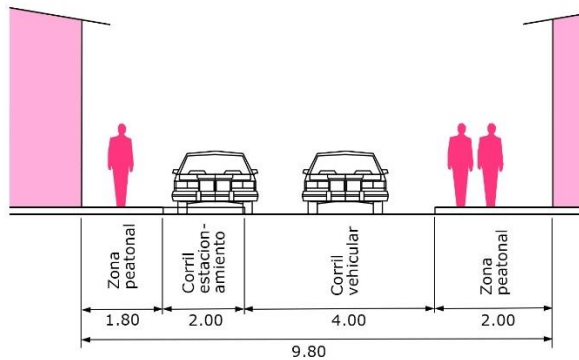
Perfil de acera calle 1ra poniente norte. Fuente: Elaboración propia
